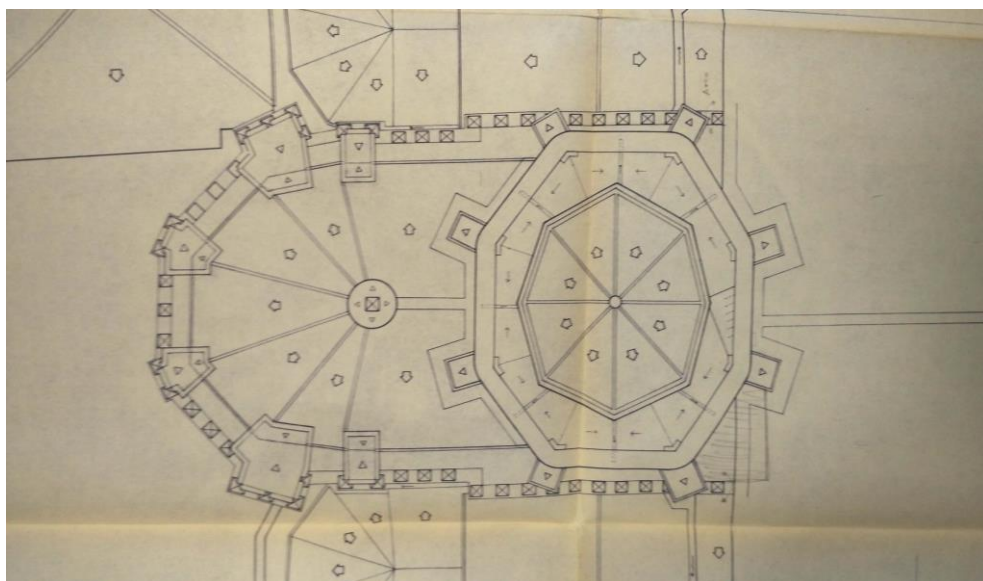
Cubiertas del transepto estado reformado. Archivo Administración D.G.A.
